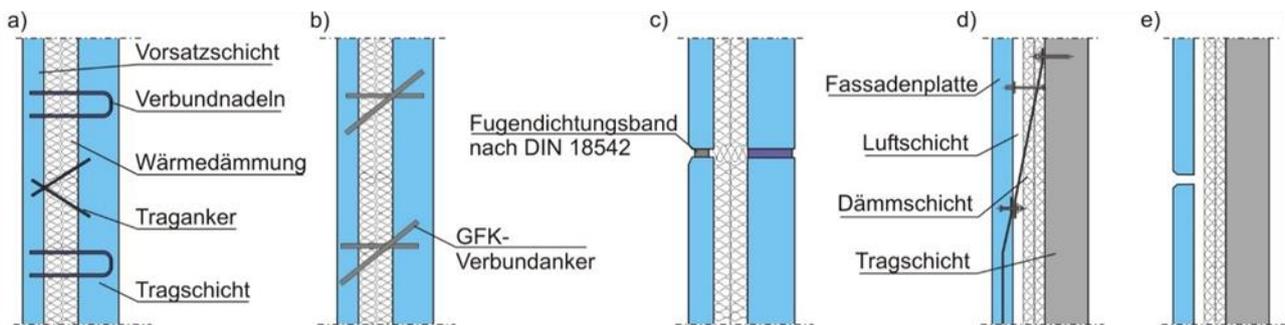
Prinzipielle Fassadenausbildungen und typische Fugendetails, a), b) und c) Sandwichelemente, d) und e) vorgehängte Fassadenplatten
